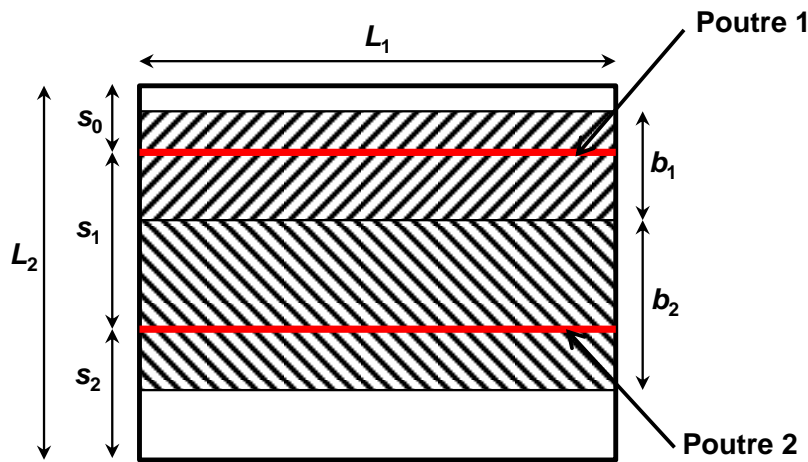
Disposition générale d'un plancher mixte ($n_{ub} = 2$)
